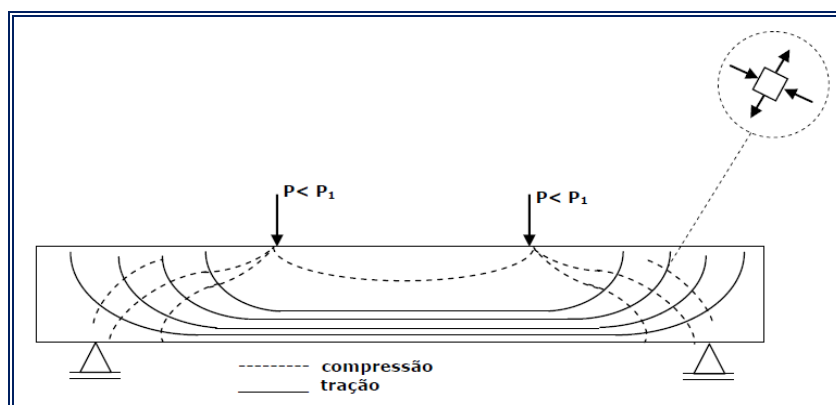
DISTRIBUIÇÃO DE TENSÕES DO ENSAIO DE STUTTGART.
